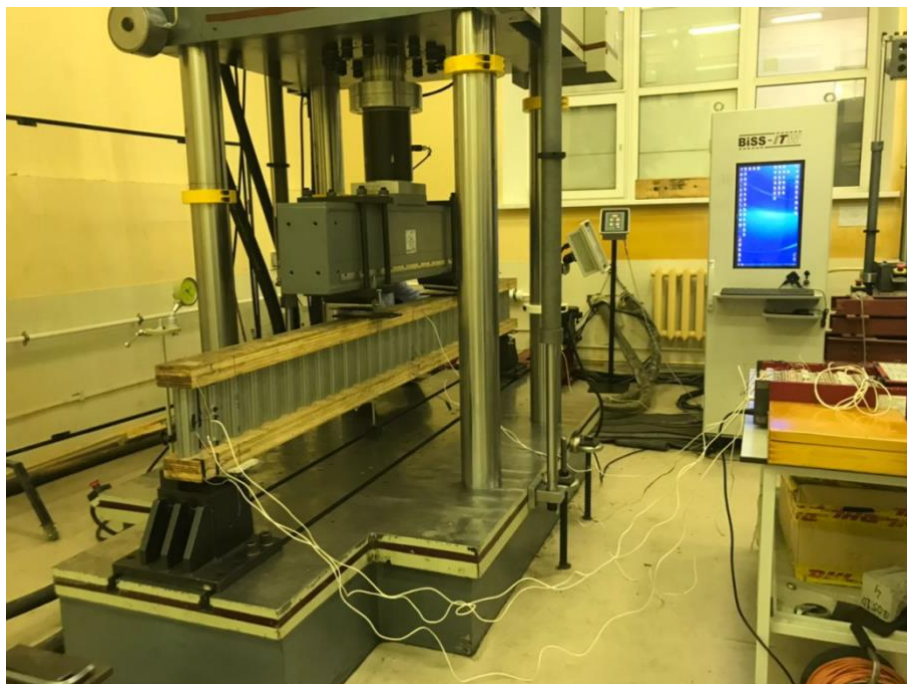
Установка балки №1 на испытательный стенд
